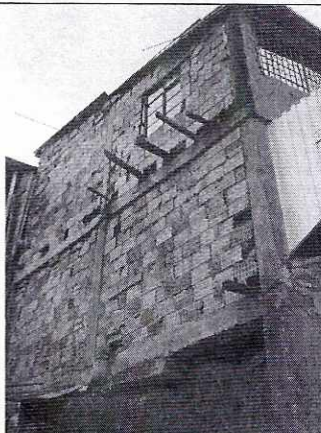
Vista posterior en la que se evidencia elementos estructura de soporte. No se observa daños
